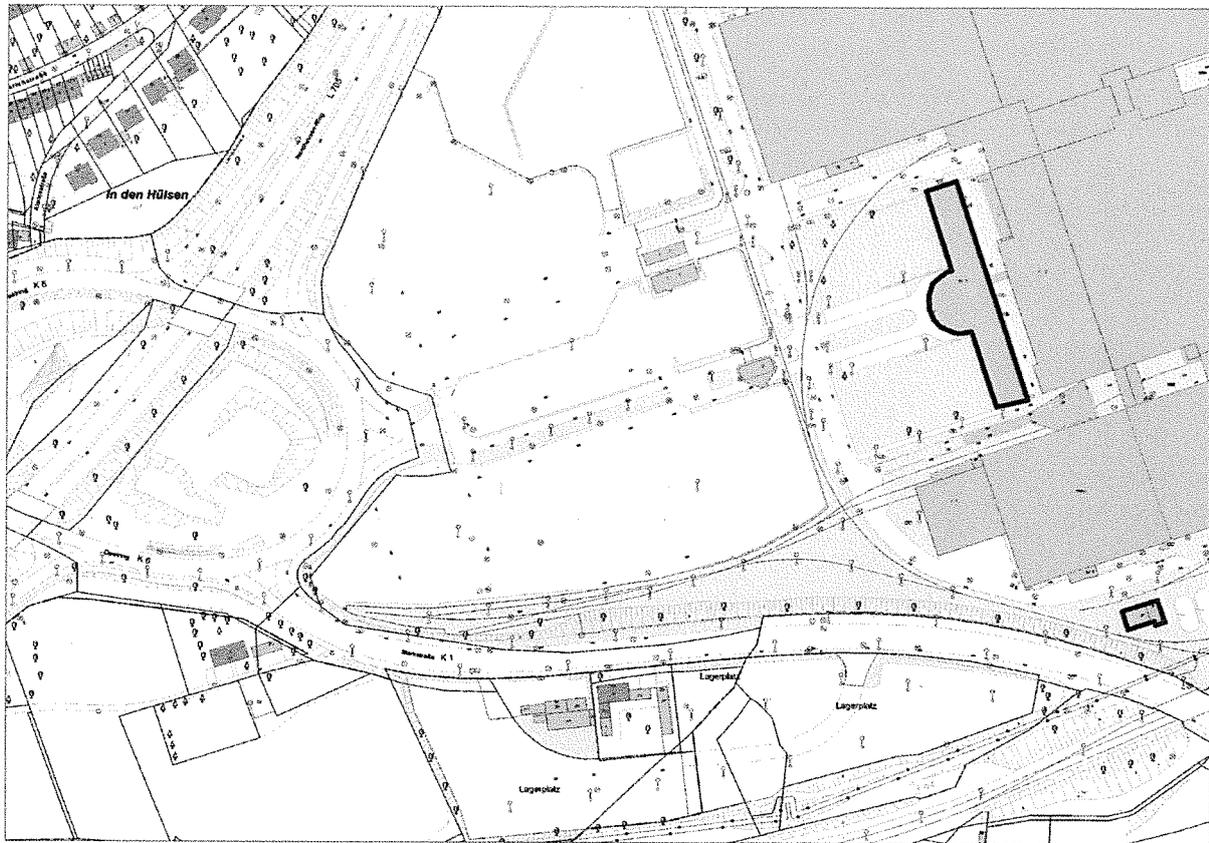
Lageplan, Abgrenzung des Baudenkmals
